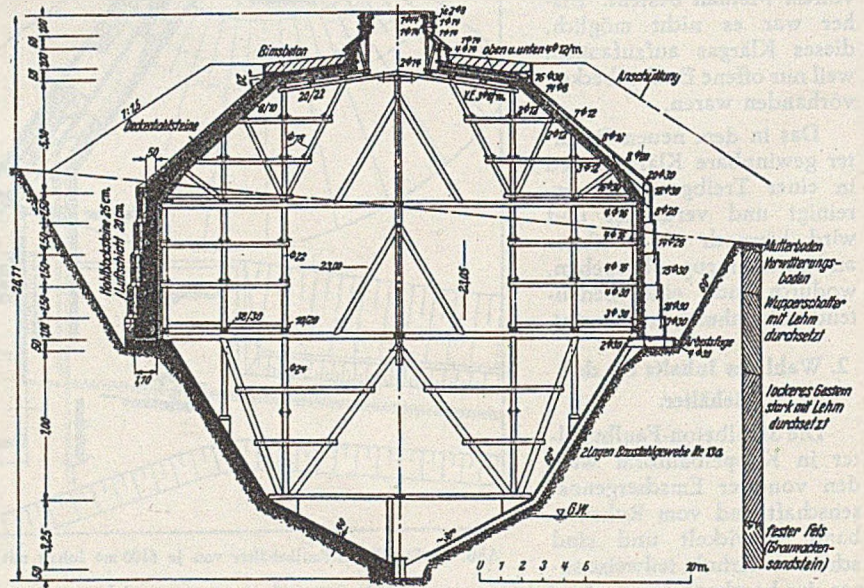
Abmessungen des Behälters mit Darstellung des Lehrgerüsts, der Bewehrung und des Wärmeschutzes.
